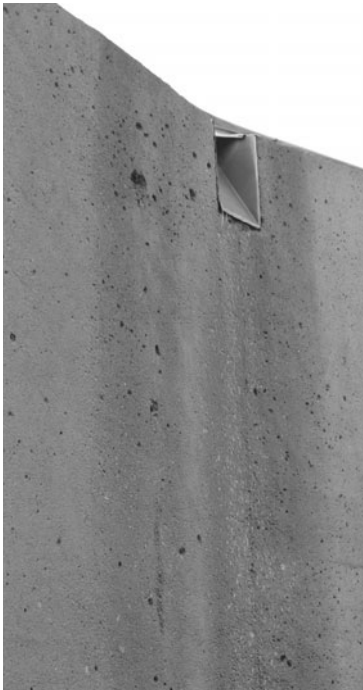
Sichtbeton oder „be-grünte“ Fassade?
